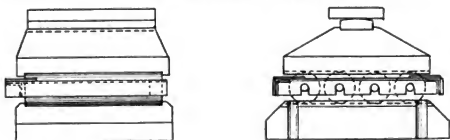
u. 368. GERBERSCHES festes Tangentialkipplager. M. 1 : 20.
